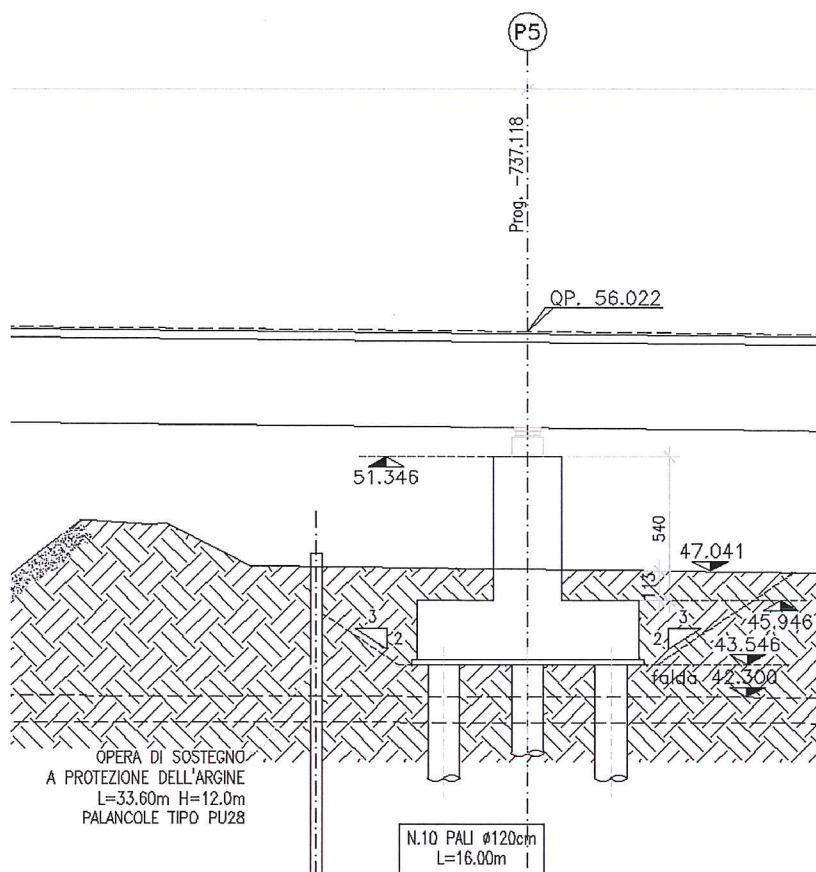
SEZIONE LONGITUDINALE PILA P5
